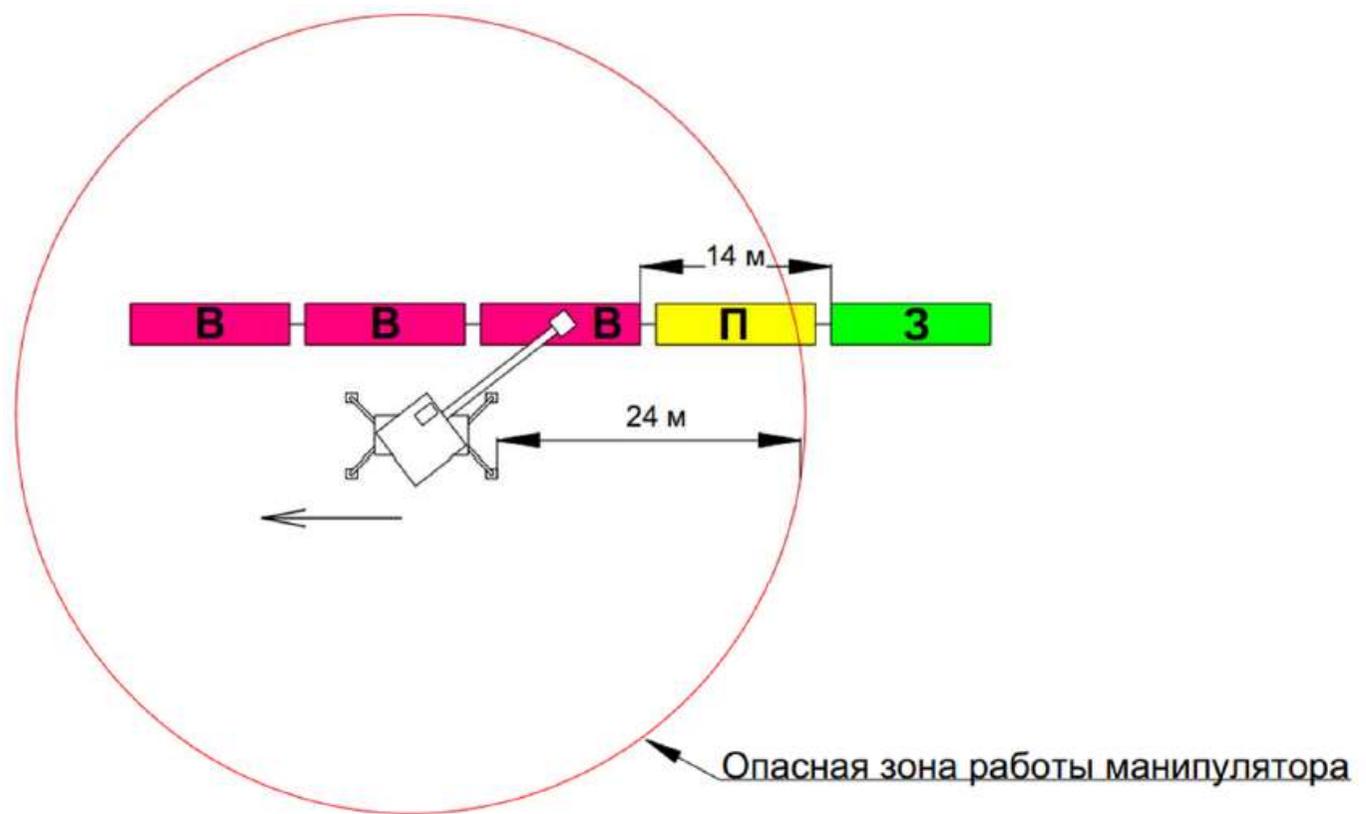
Схема выгрузки угля электропортальным краном и манипулятором
